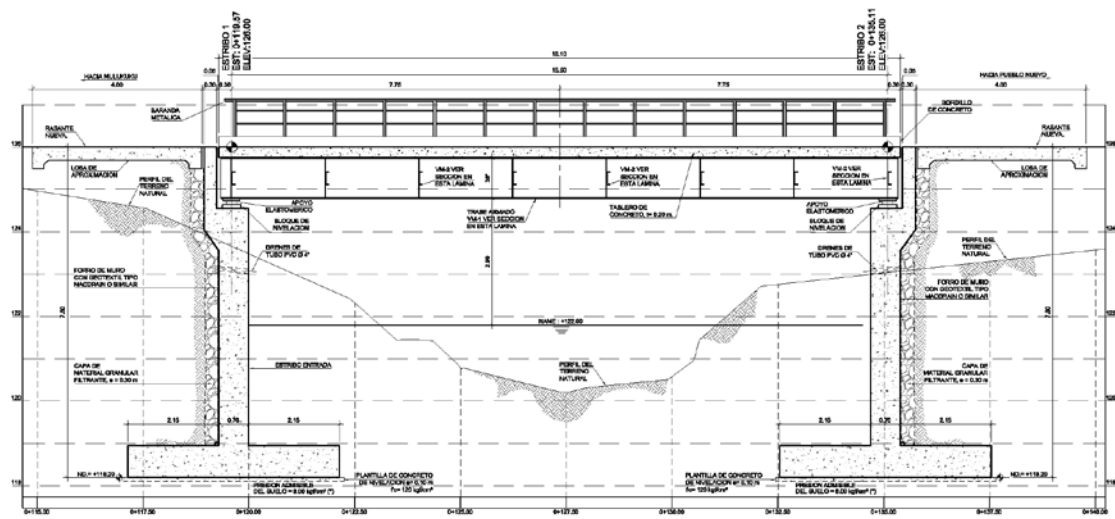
Perfil longitudinal del Puente Santa Rosa
